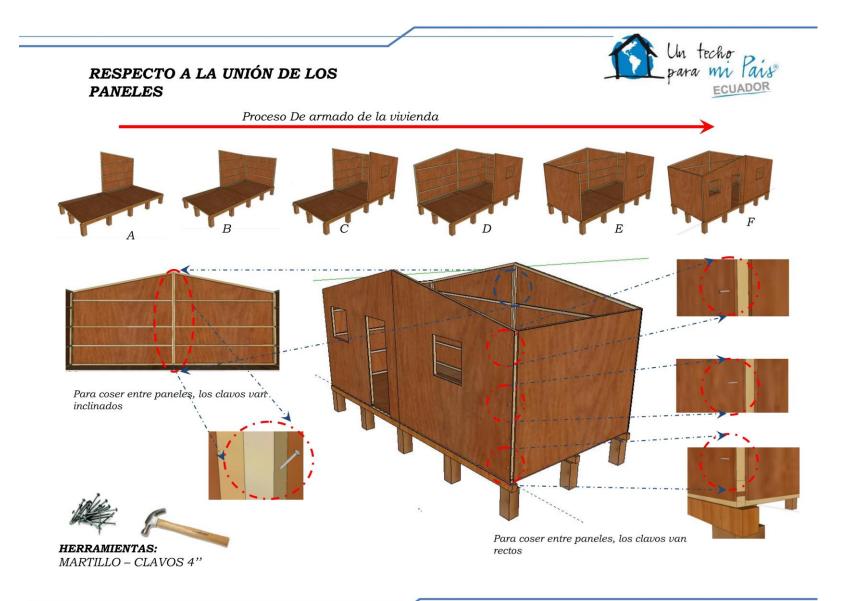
Unión de paneles, Fuente: Manual para la construcción - TECHO
